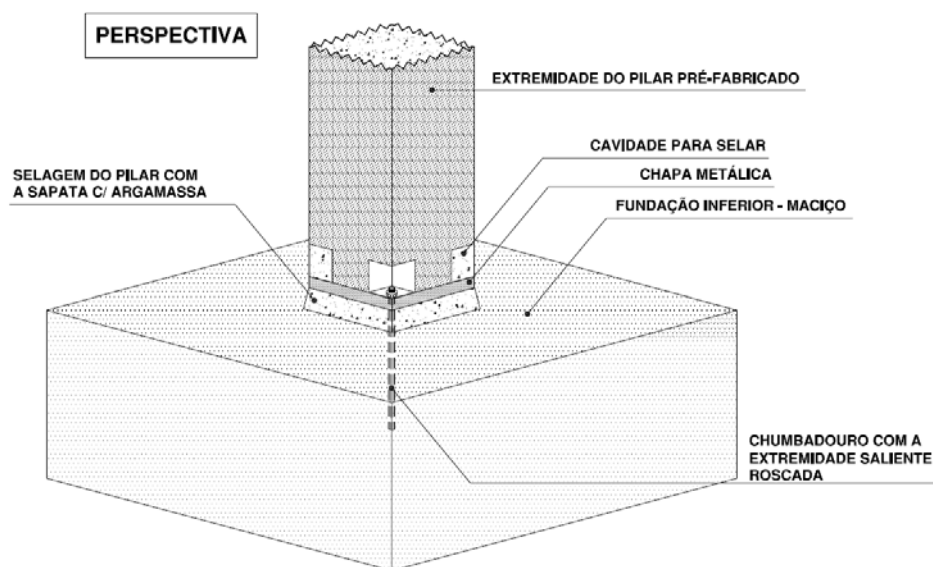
Ligação pilar-fundação com ferrolhos aparafusados (adaptado de [1])
